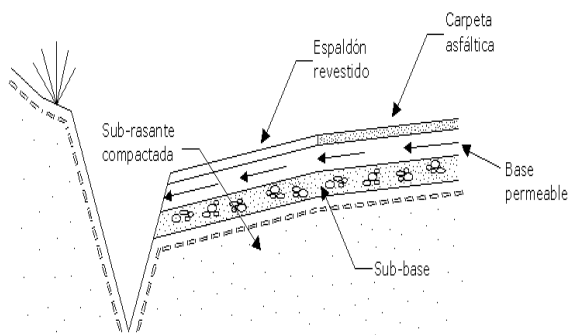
Detalle típico de una sección de camino con pavimento asfáltico. (Fuente: Conservación de caminos: un modelo participativo).
